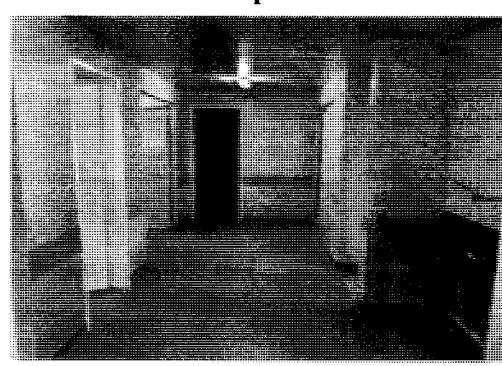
Pintura epoxi, bate maca e manta vinílica
